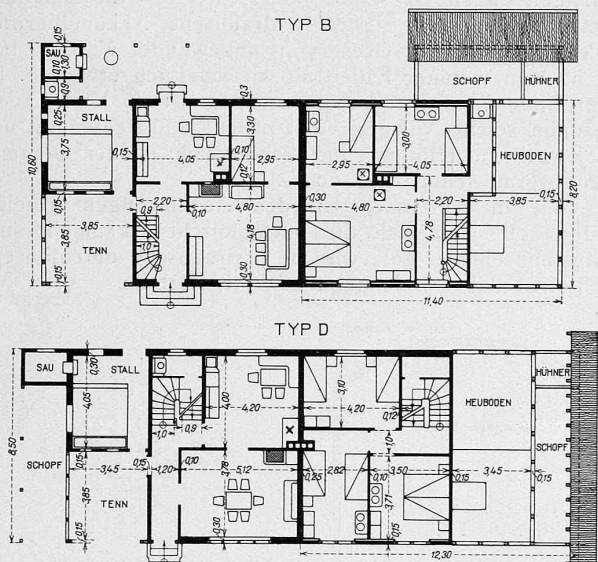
und 9. Grundrisse vom Erdgeschoss und vom 1. Stock der Doppelwohnhäuser Typ B und D.
